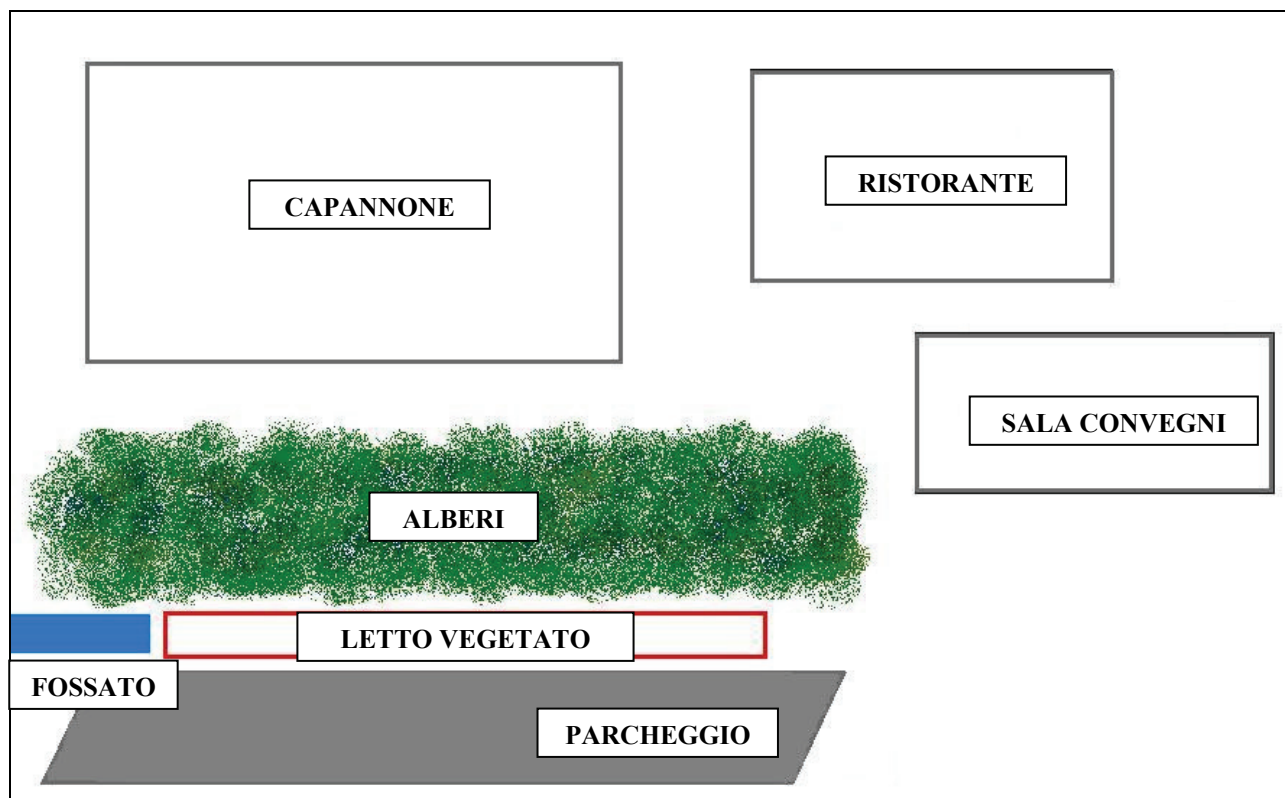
Ricostruzione planimetrica del complesso servito dall'impianto A (particolare)
